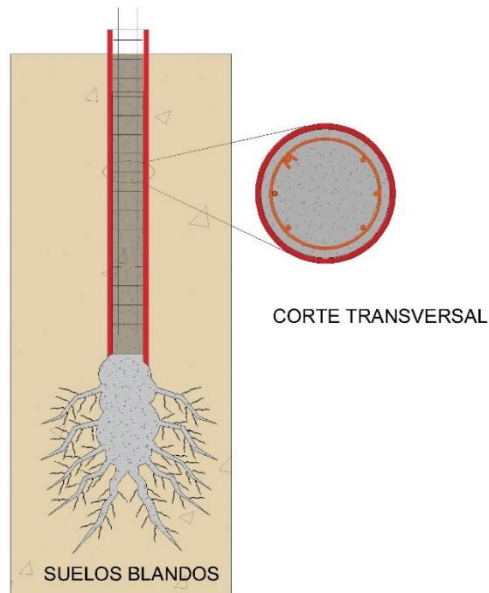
Detalle de la sección transversal del pilote inyectado y reinyectado con lechada cementicia construida.
